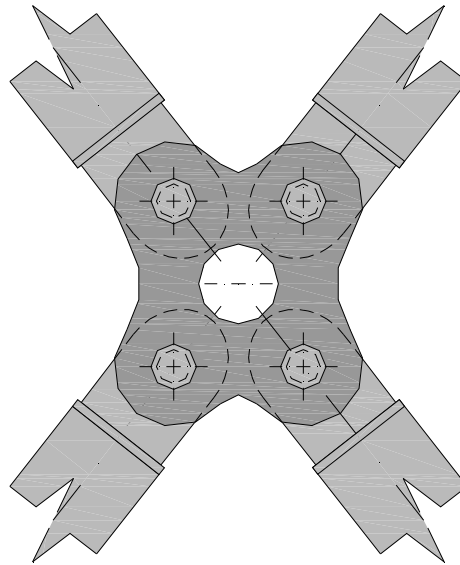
DETTAGLIO DEL COLLEGAMENTO DEI CONTROVENTI Ø193.7X11
